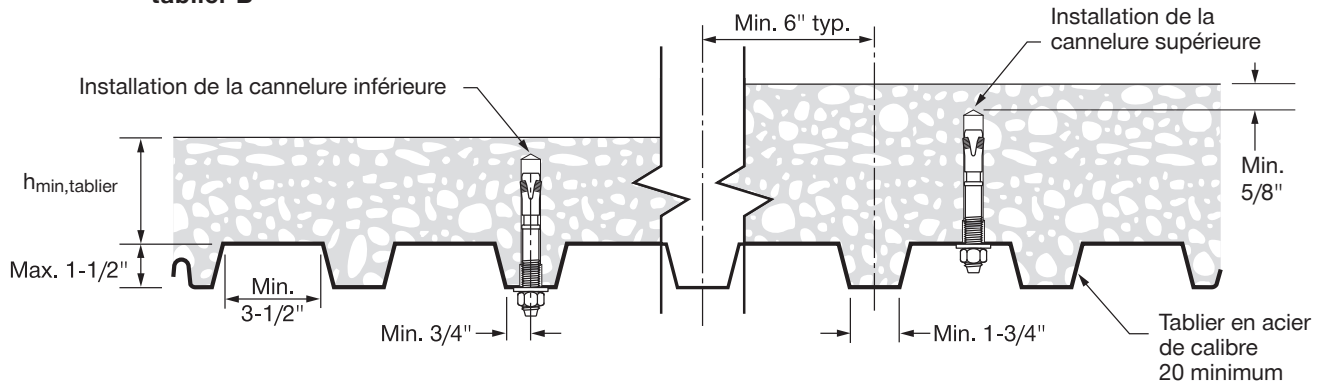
Installation dans le soffite de béton sur des assemblages de planchers et de toits en tablier métallique – tablier B
